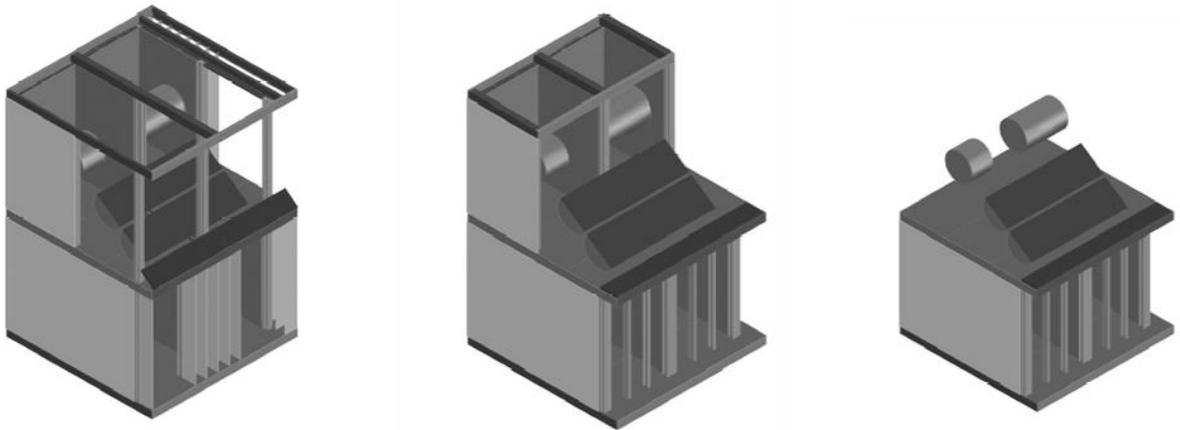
a) Modulo armado completo b) con reducción del volumen de tanques c) Sin la planta superior
